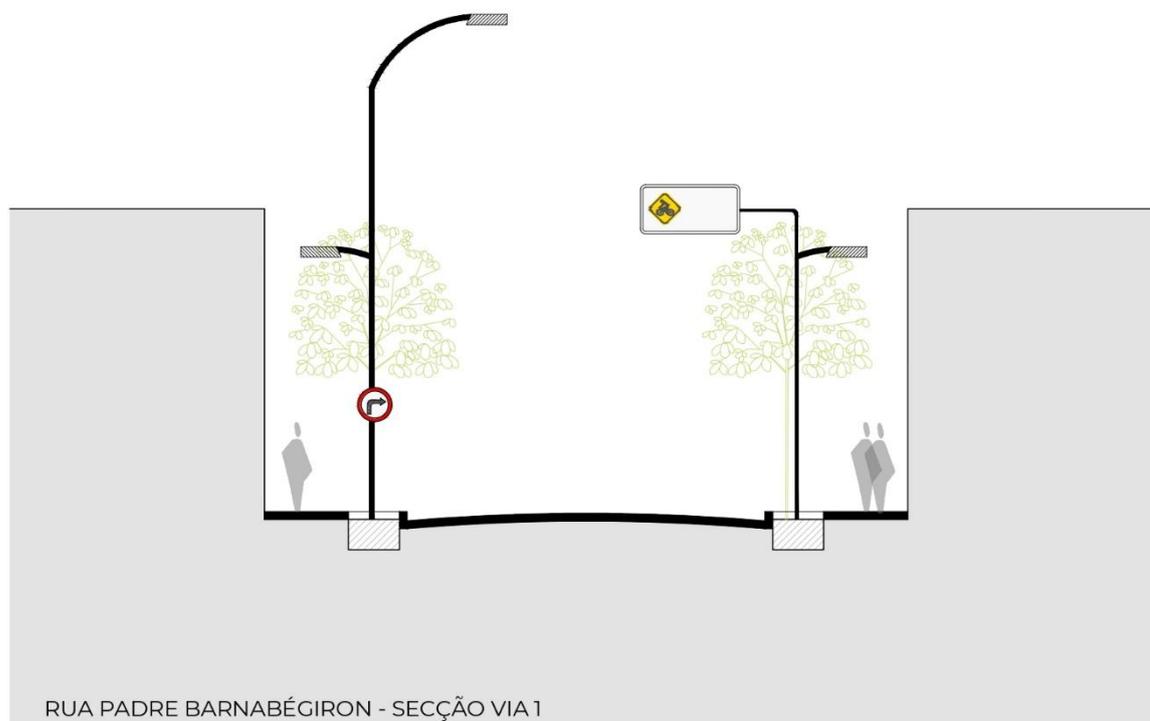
Corte esquemático da Avenida Padre Barnabé Giron.
